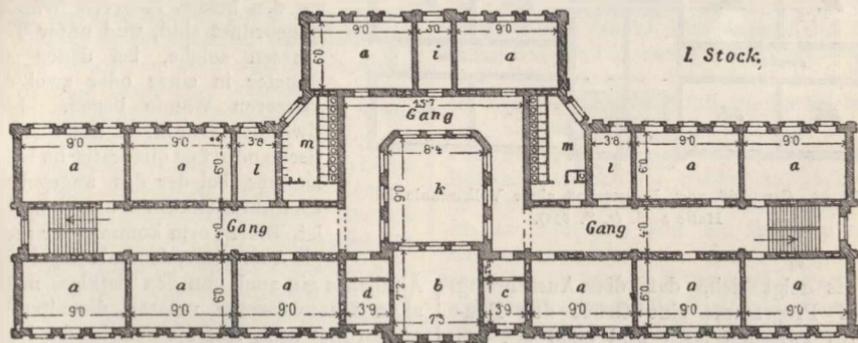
Grundriß des Volksschulhauses in Dresden.
